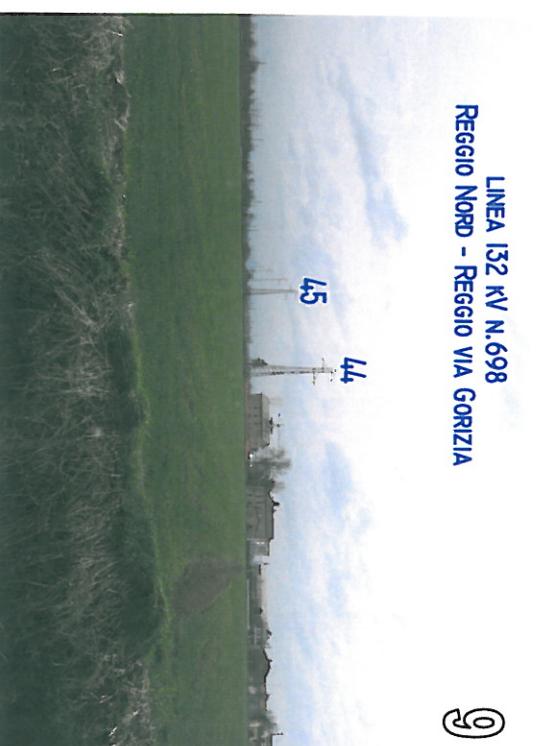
da via Beretta vista verso Sud Ovest; tratto in cavo aereo tra la via Beretta e la via Peschiera.
